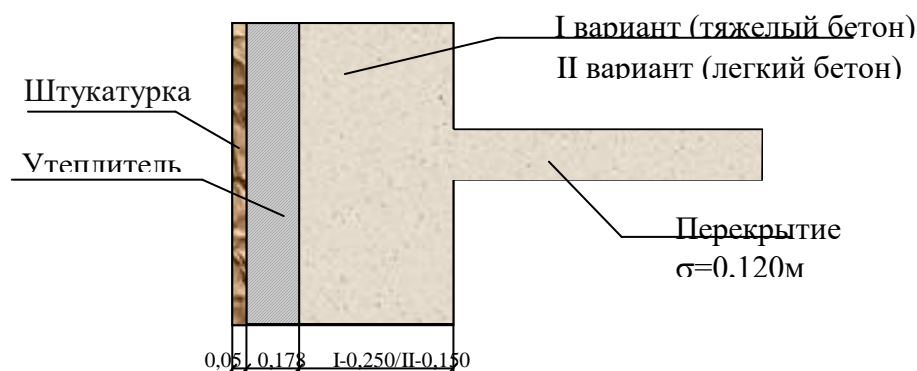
Расчетная конструктивная схема наружной стены и перекрытия.
